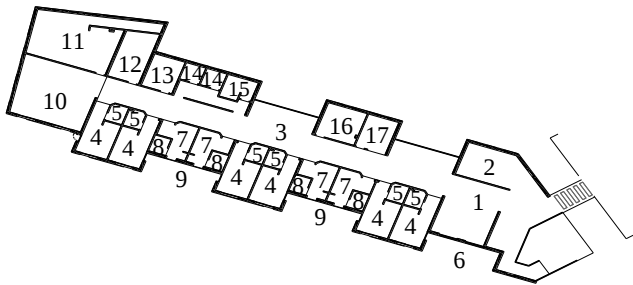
| Planta esquemática do Piso Térreo - Bloco de Internamento.
